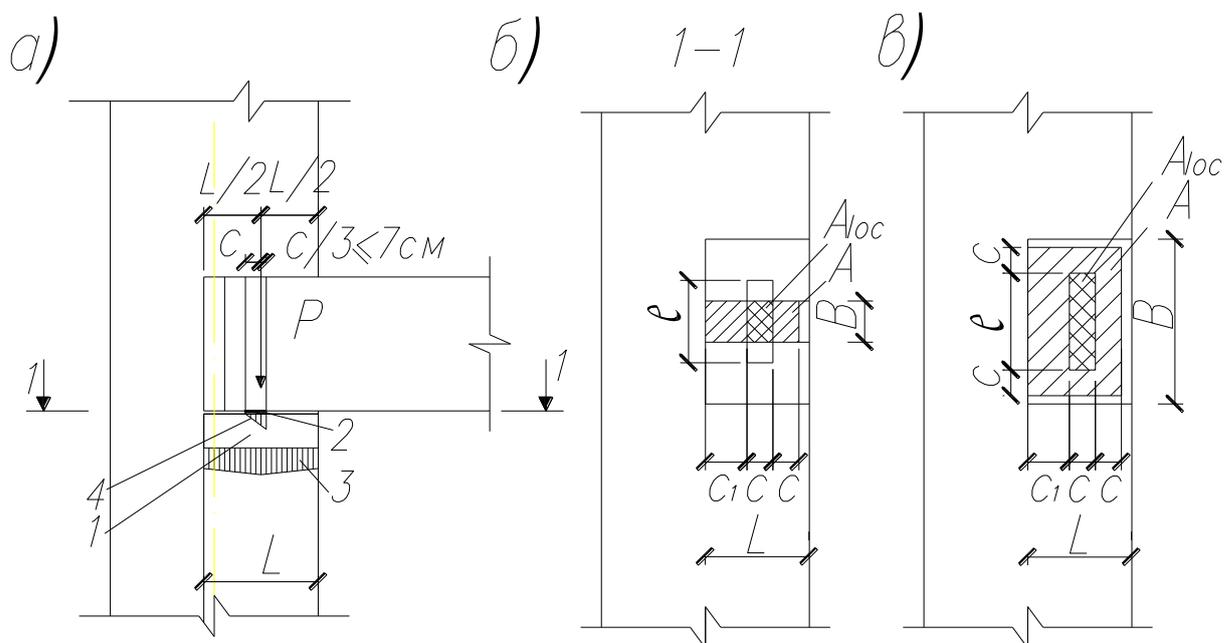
Схемы к проектированию опорной плиты с фиксирующей прокладкой: 1 - опорная плита; 2 - фиксирующая прокладка; 3 - эпюра напряжений в кладке под плитой; 4 - эпюра напряжений в бетоне на контакте с фиксирующей прокладкой
